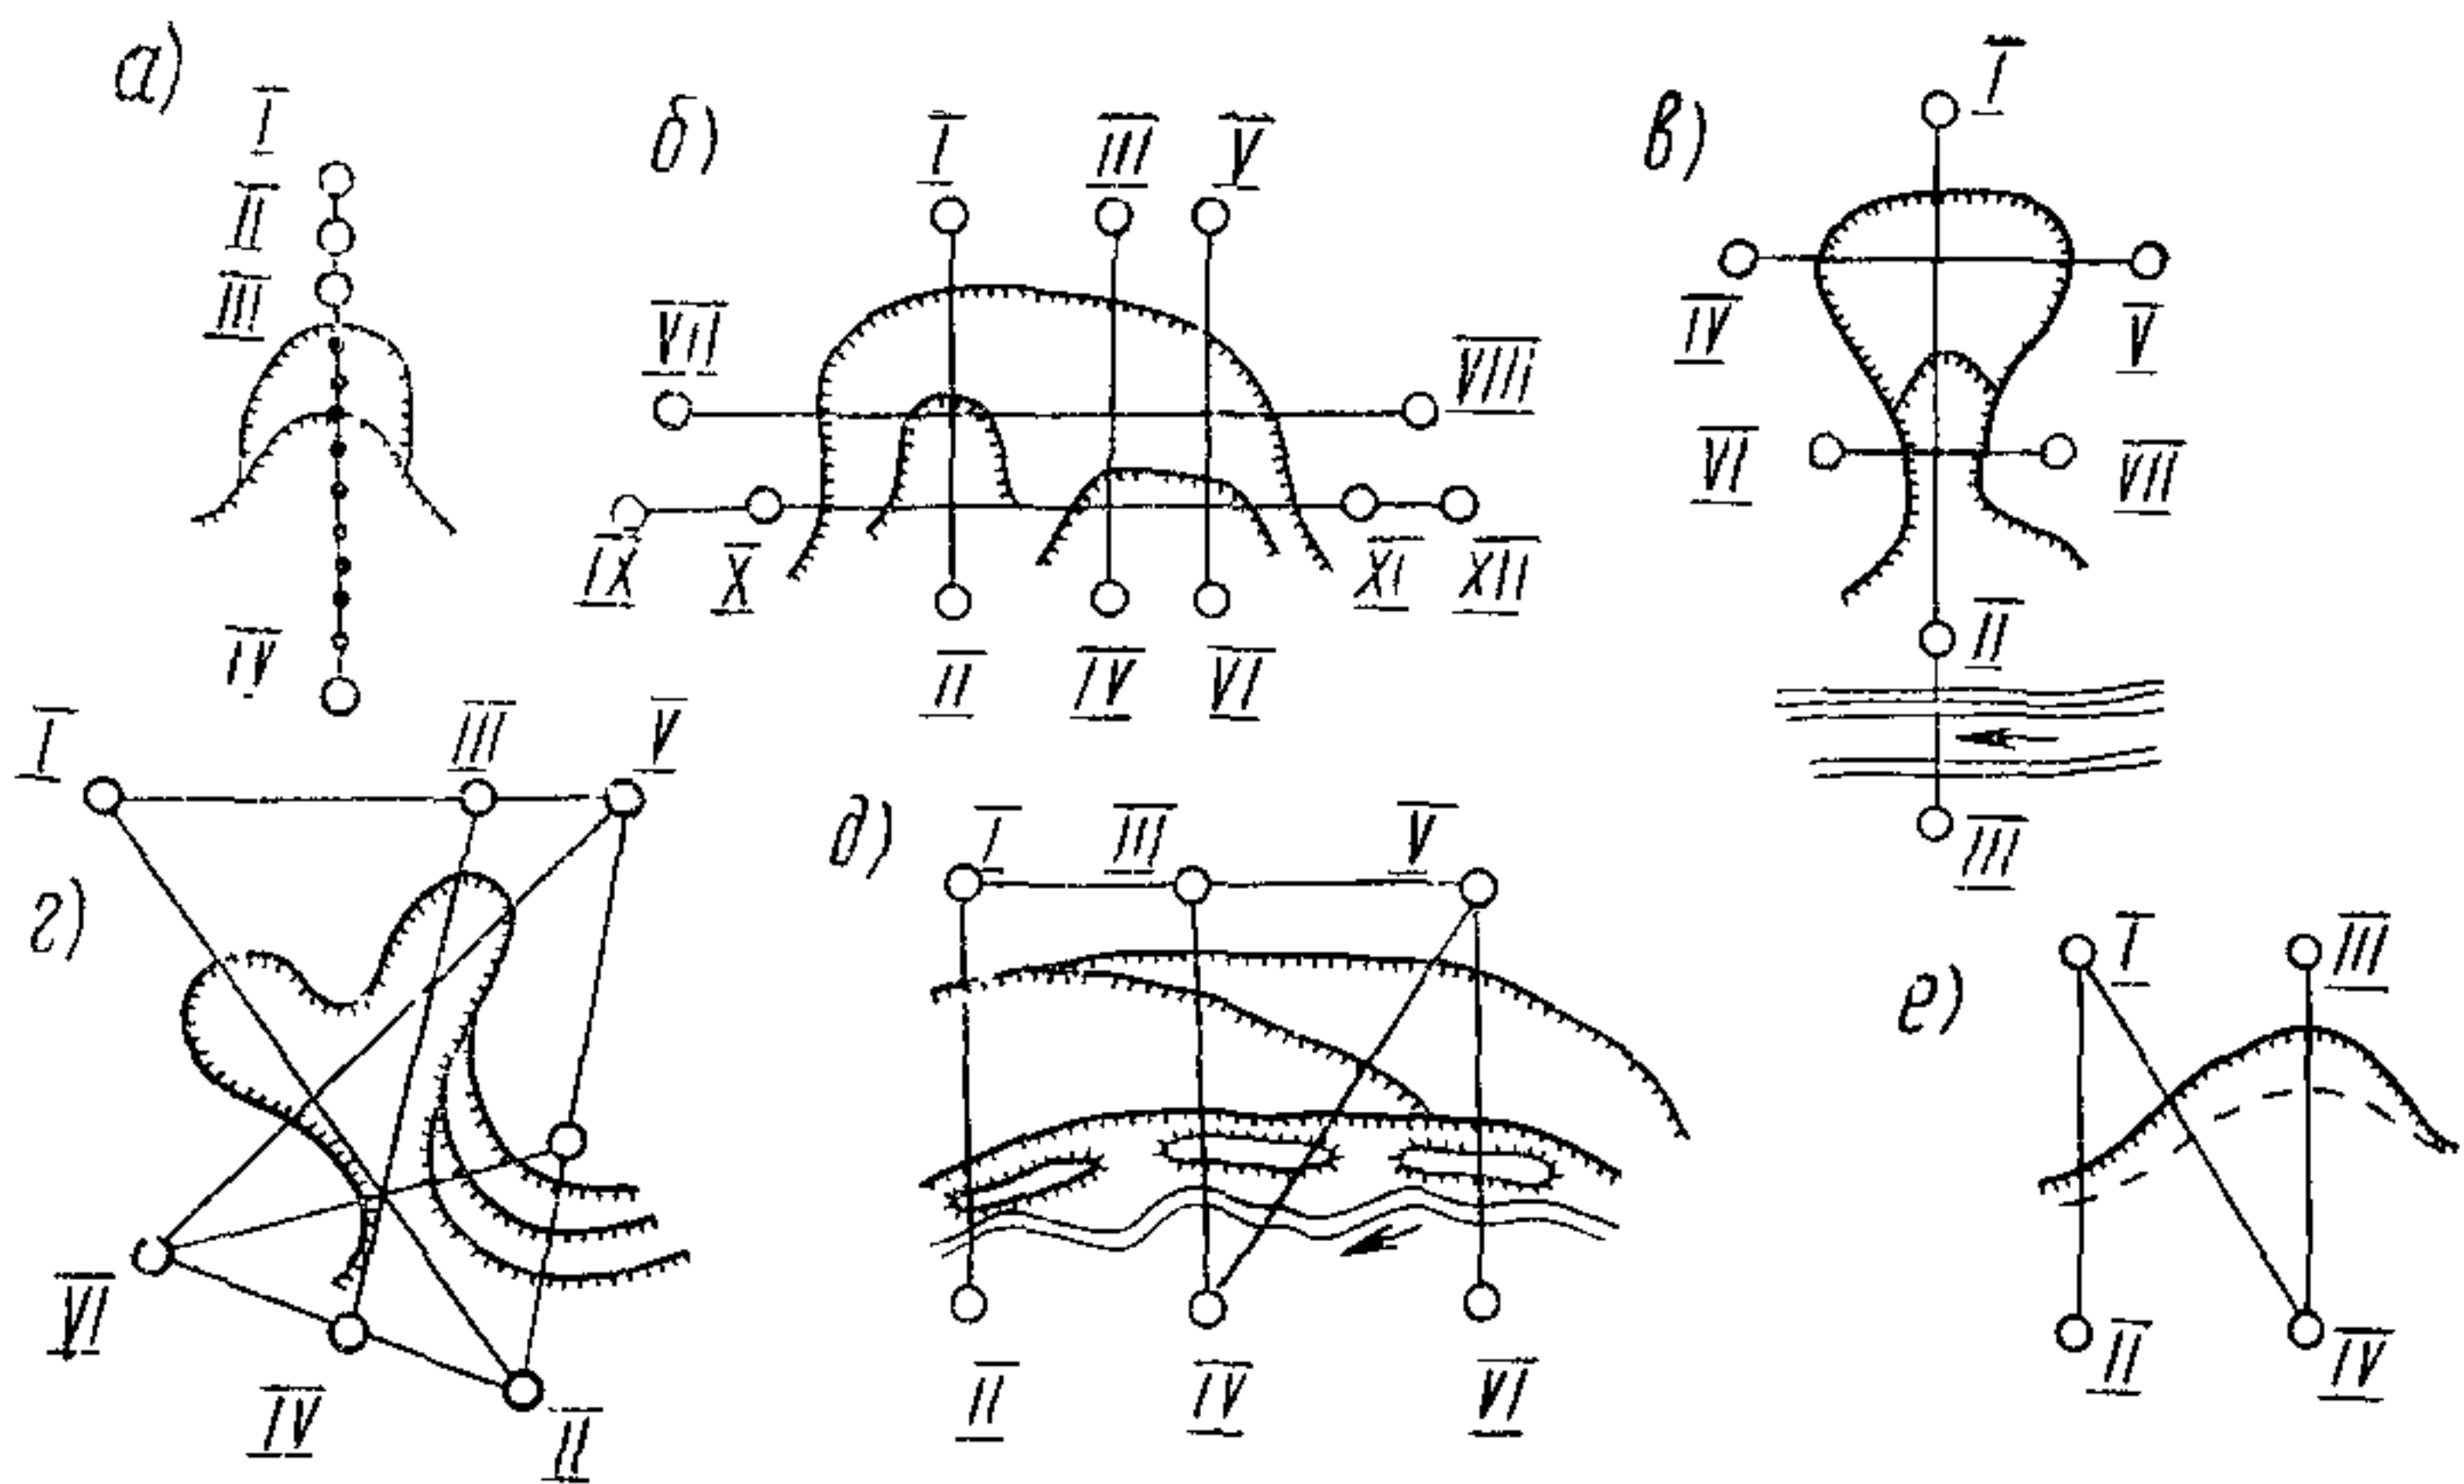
Примерные схемы размещения продольных и поперечных створов на оползнях
